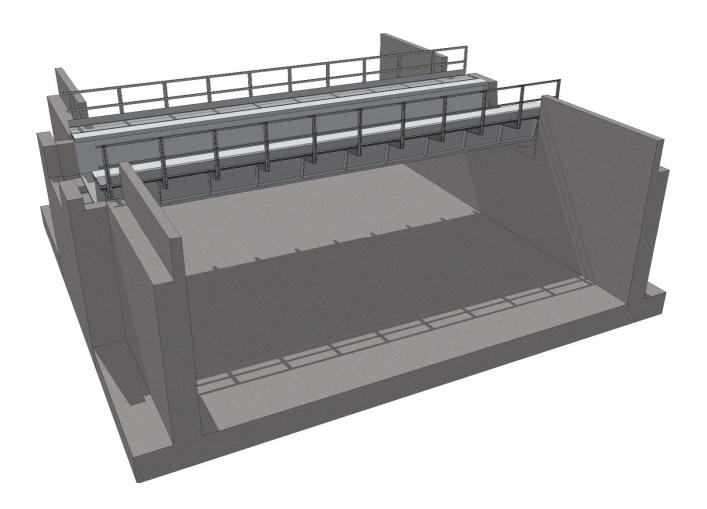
si riportano, rispettivamente, la pianta, la sezione longitudinale, trasversale e delle viste tridimensionali delle opere di sottostruttura.
